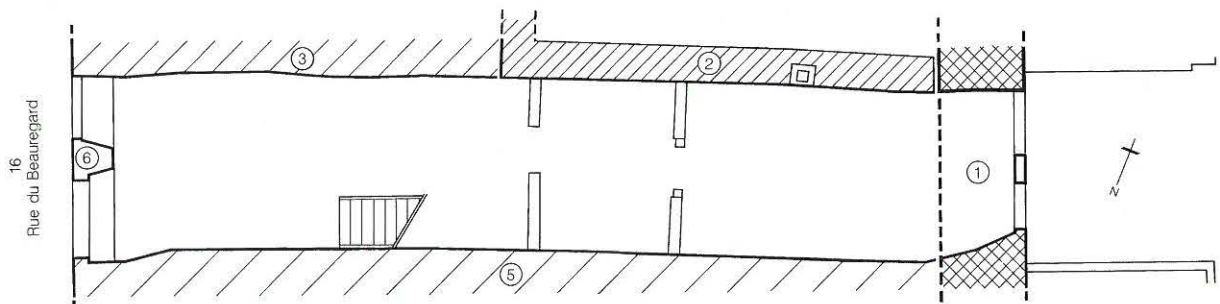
La Neuveville, Rue du Beauregard 16. Plan. Echelle 1:150.
